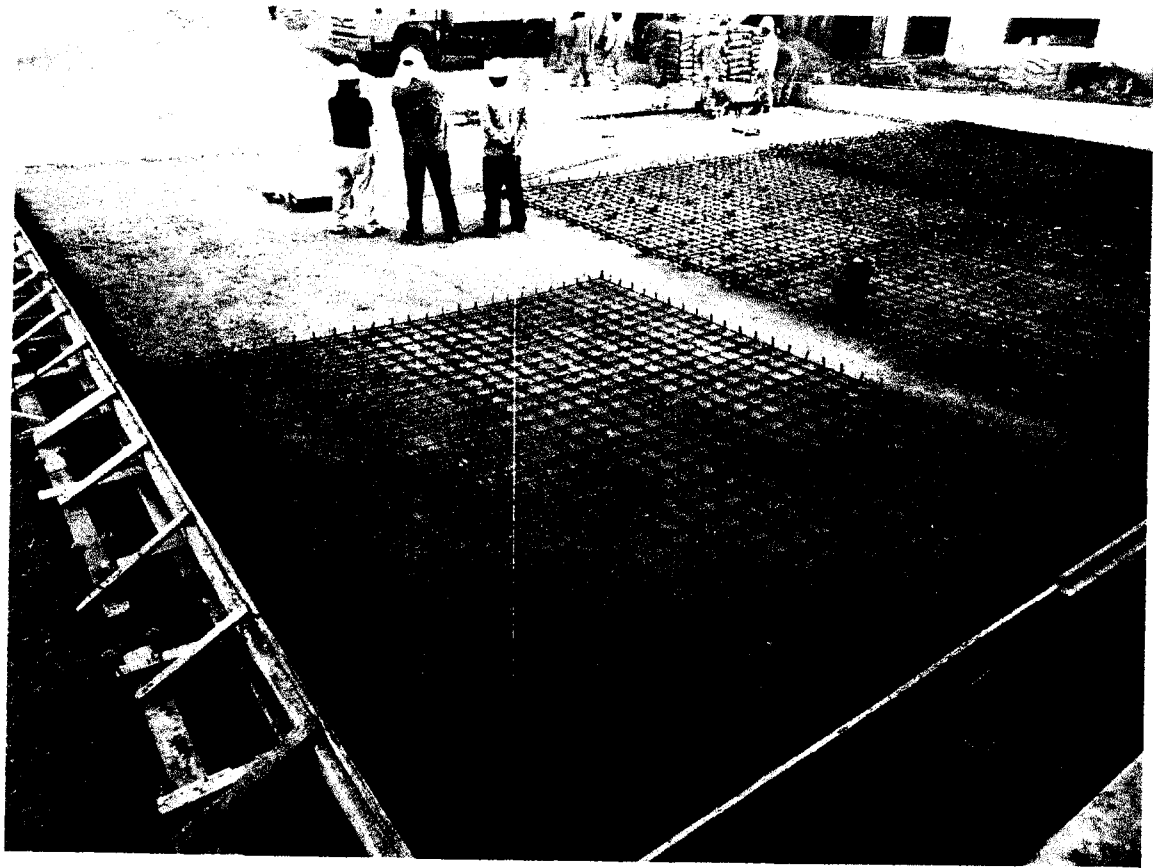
Encofrado y colocación de mallas de acero de refuerzo para pavimento rígido.
